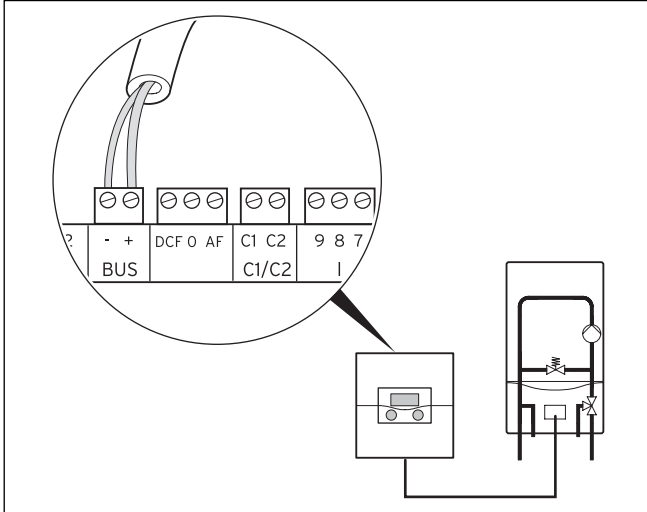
Collegamento dell'apparecchio di riscaldamento
